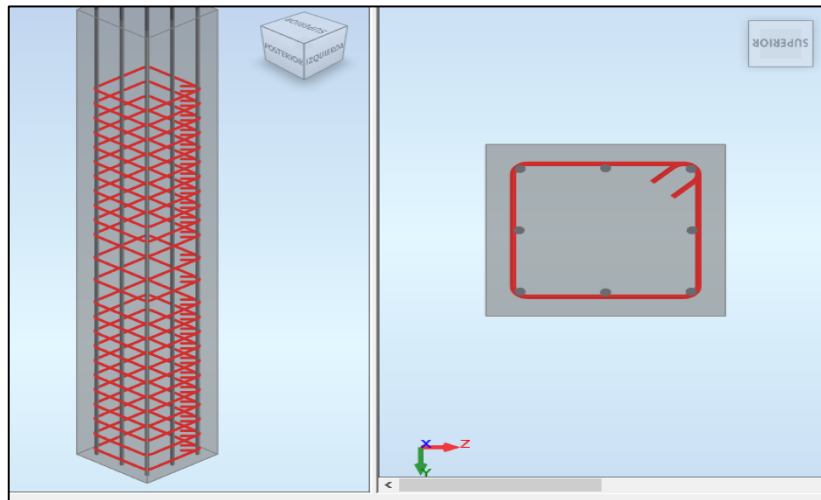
modelo tridimensional y diseño final de la distribución de los aceros de la columna C01-01.
